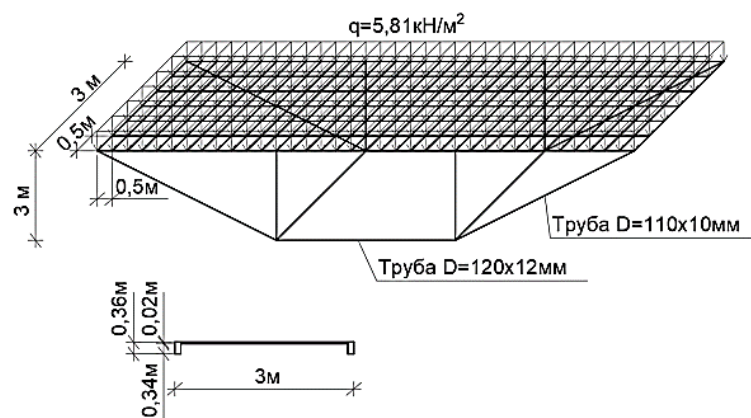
Розрахункова схема для 2-го варіанта підкріплення Розрахунок плити на задане навантаження виконаємо за ПК SCAD
